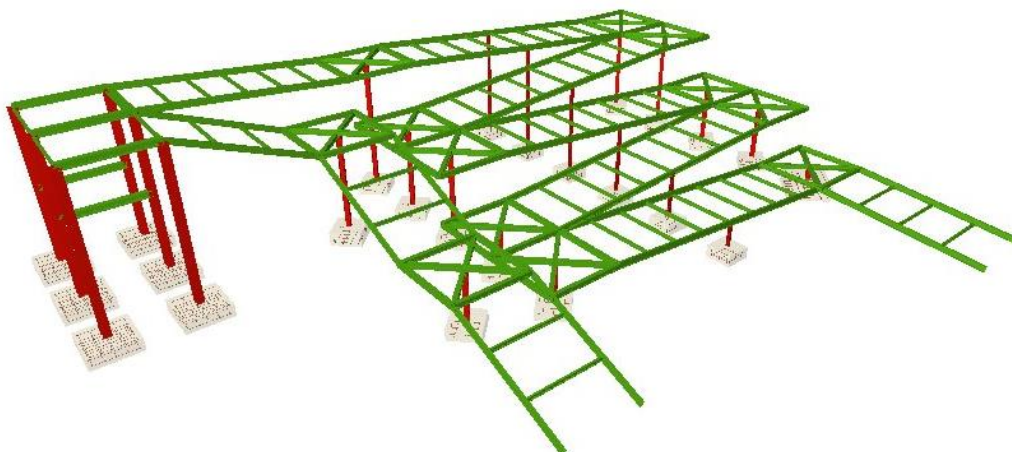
Modelo 3D de rampas y escalera lado este (Cype)
